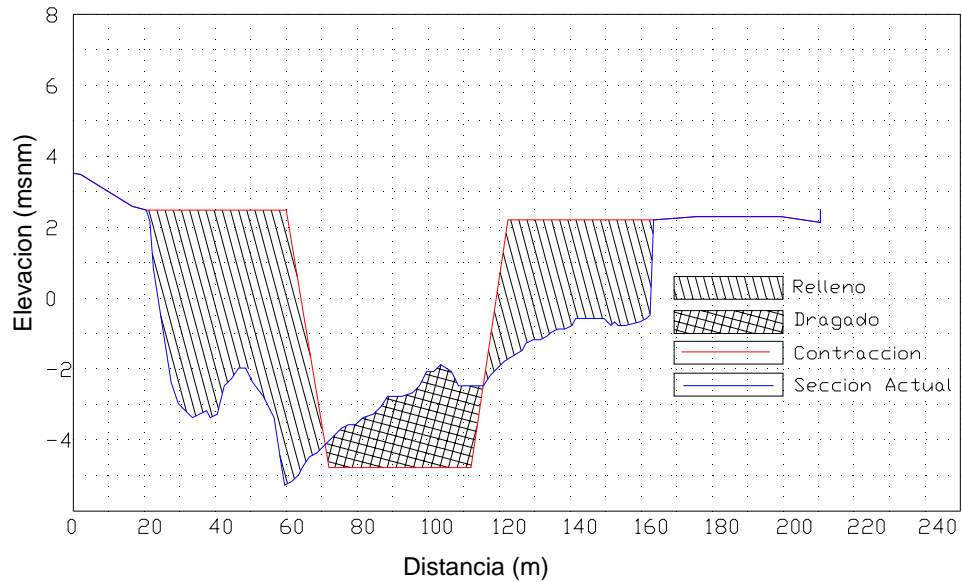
Sección transversal km 76 - Contracción No. 3
